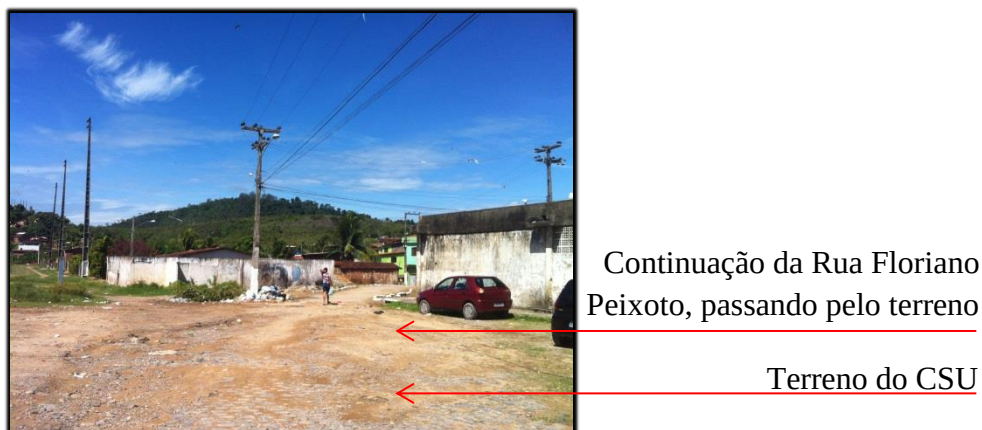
Rua Floriano Peixoto e o terreno de fundo
